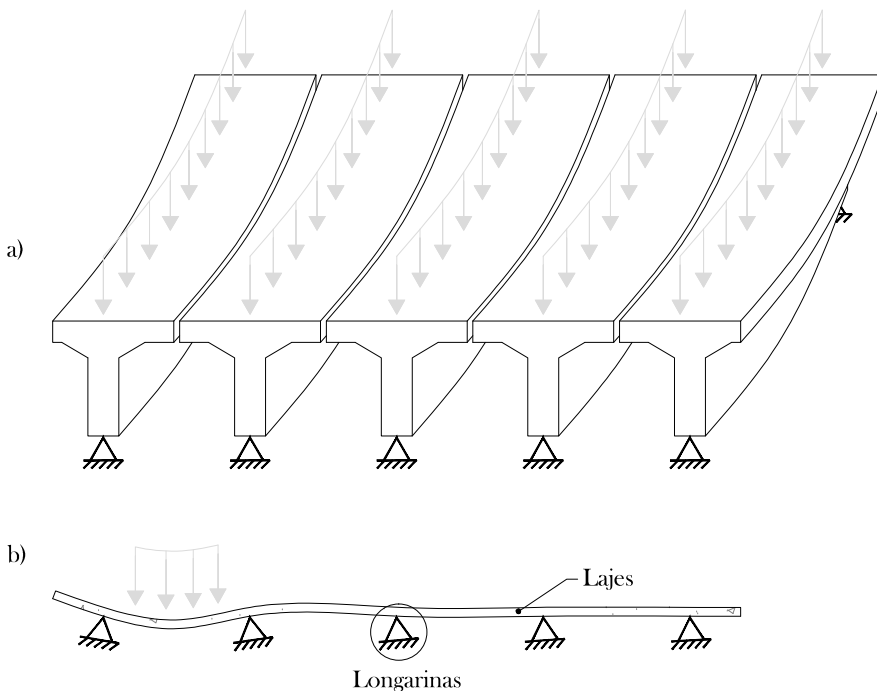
Análise estrutural de pontes em viga: (a) tratamento do tabuleiro como sendo diversas vigas isoladas; (b) deslocamentos transversais da seção considerando as lajes como barras contínuas e as longarinas como apoios indeslocáveis. Fonte: adaptada de Hambly (1991).
